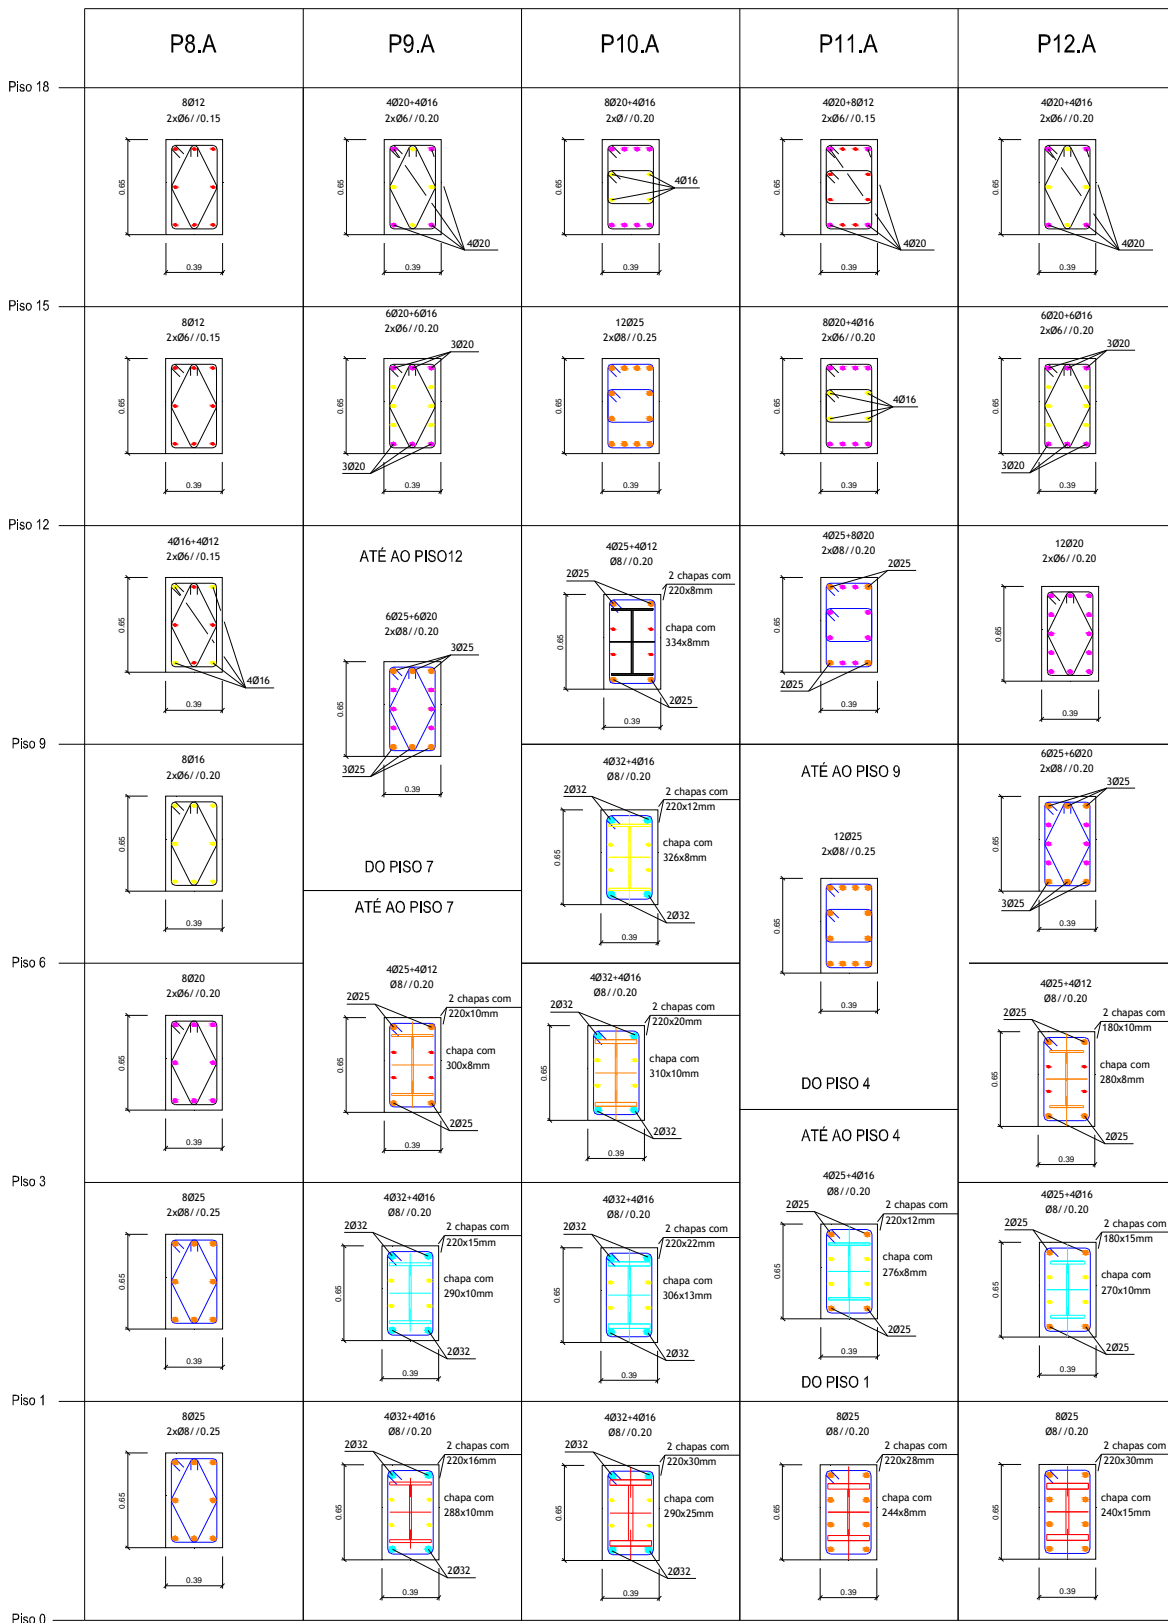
Secção dos pilares da torre do edifício Burgo
